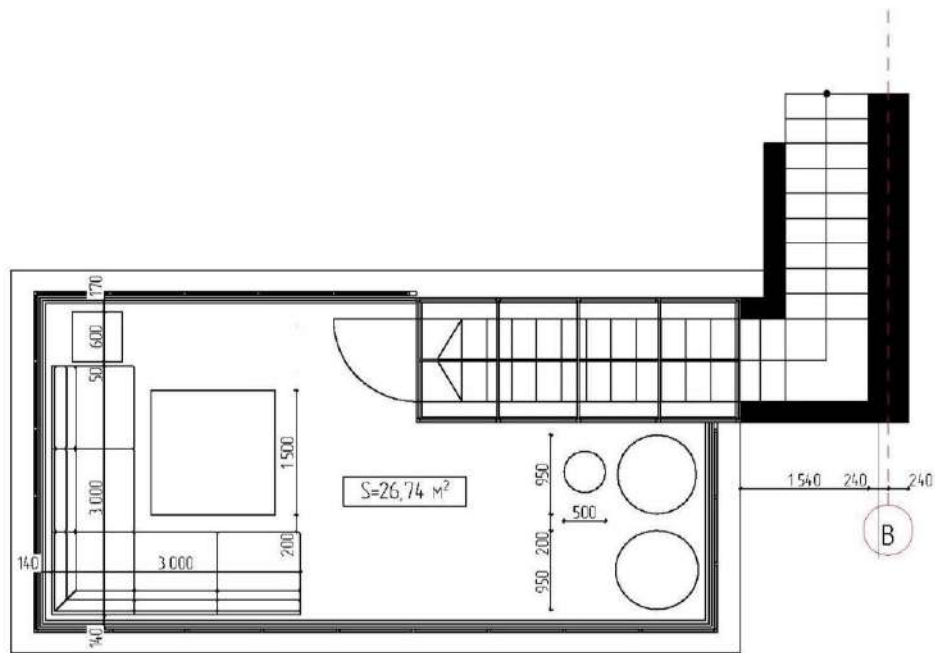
Планувальне рішення для тераси (власне креслення).
